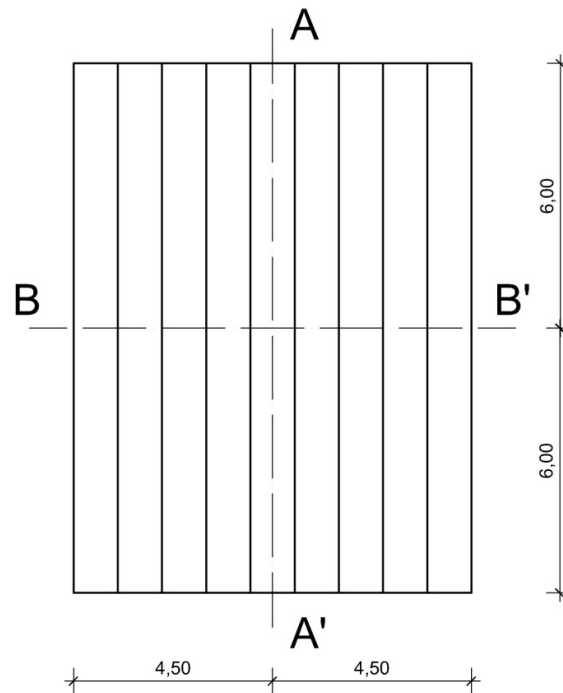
Planos de simetria, longitudinal (AA') e transversal (BB').
